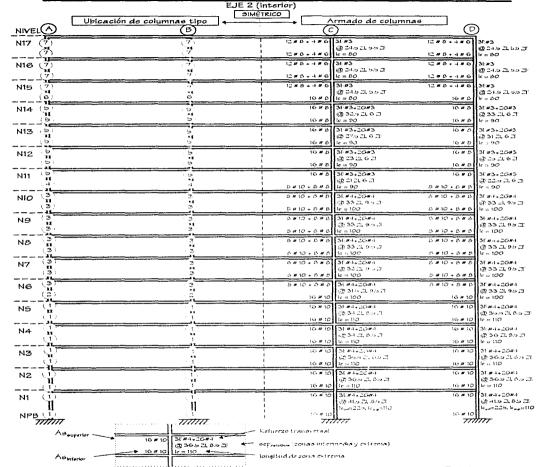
Unicación de los tipos de armados de las columnas del eje 2 de la estructura de 17 niveles discñada en la zona li
